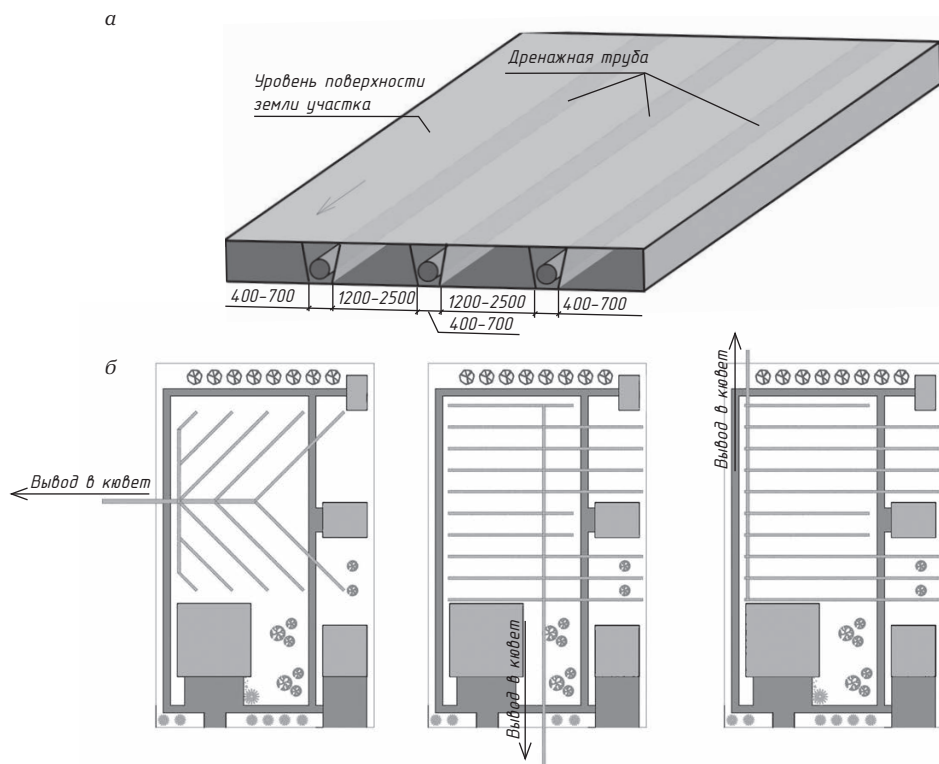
Дренажные траншеи: а — схема размещения дренажных труб; б — схема устройства дренажа
